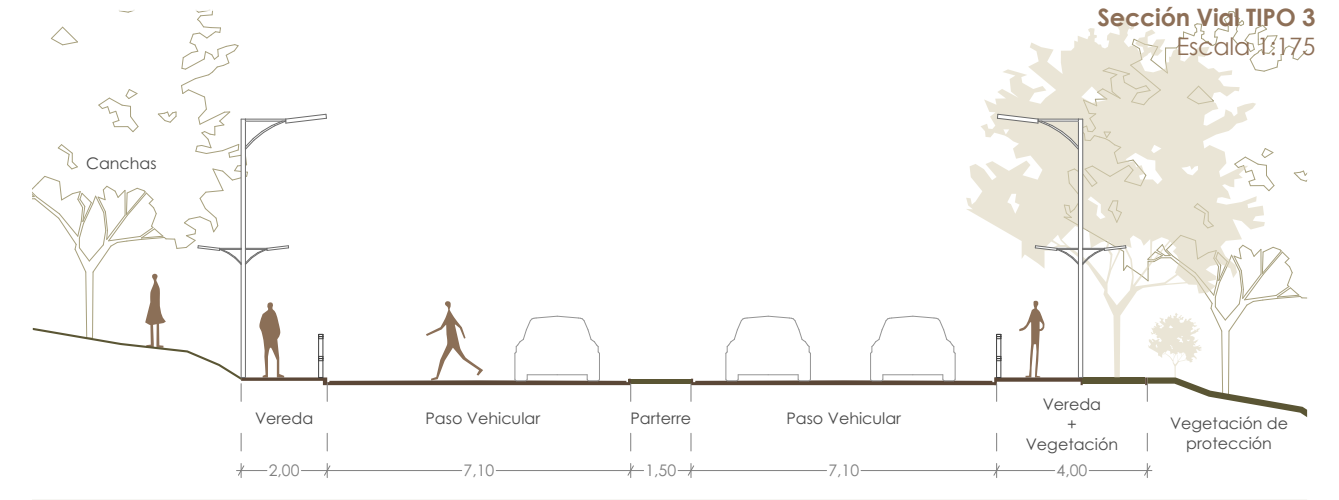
Sección vial T3. Fuente: Autoría propia.
